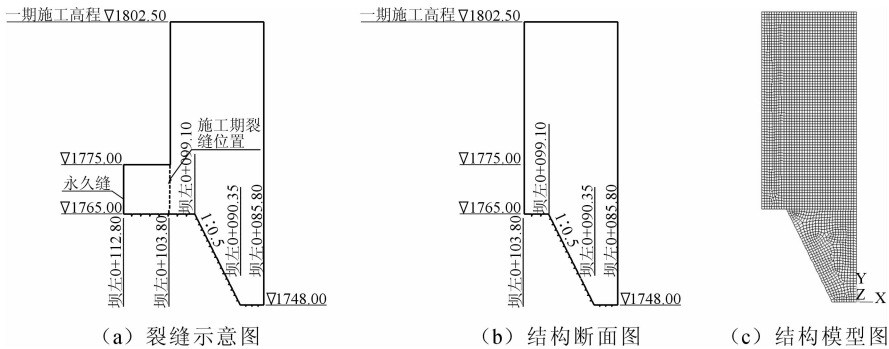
施工期右导墙裂缝断面图及结构模型图(单位:m)
